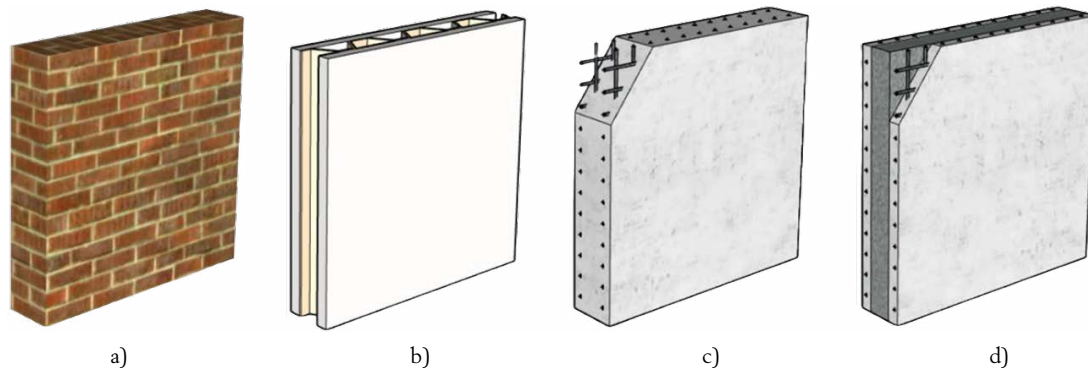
Ejemplos de soluciones constructivas para muros secundarios: (a) ladrillo; (b) placas de yeso prefabricadas; (c) hormigón armado; (d) tipo sándwich de hormigón armado (paneles prefabricados exteriores con núcleo de hormigón).
